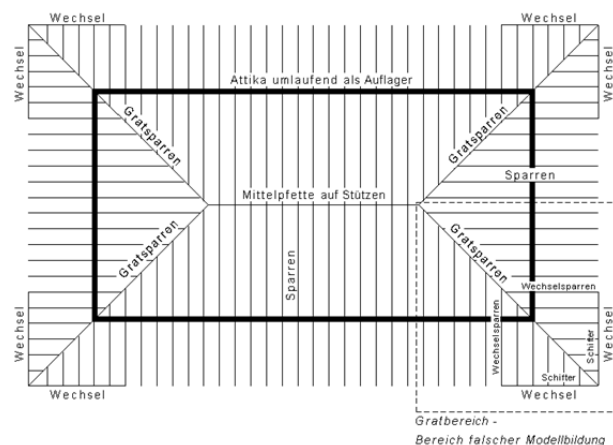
Balkenlage des Flachdaches im Grundriss
